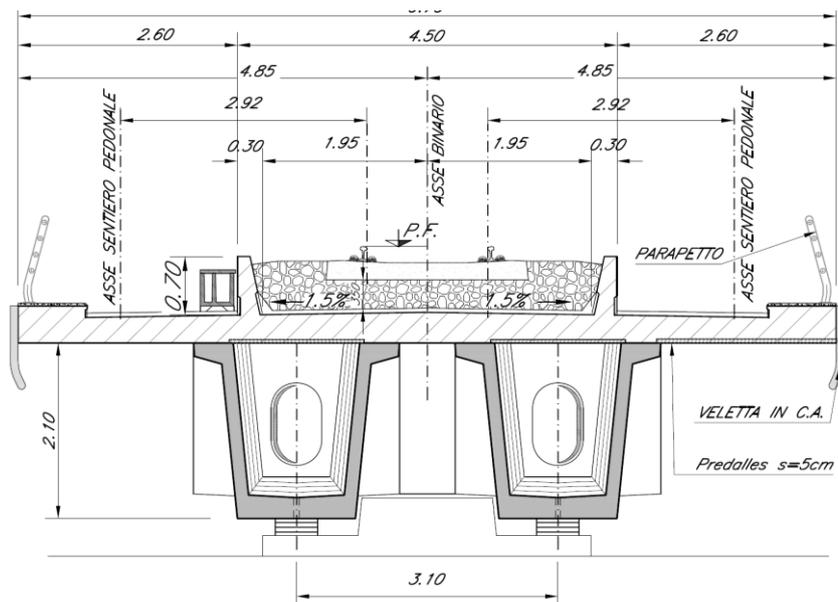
Sezione trasversale campate in c.a.p. L=25 m
